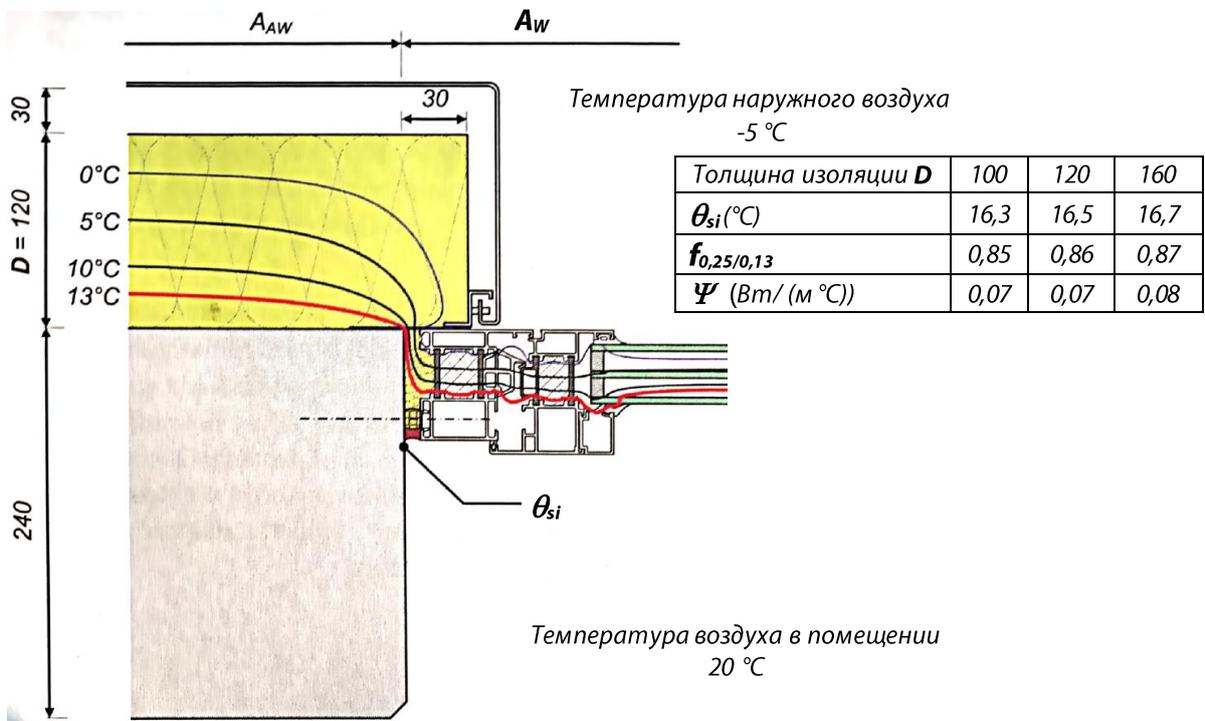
Бетонная стена с теплоизоляцией и алюминиевой накладкой, алюминиевое окно.
